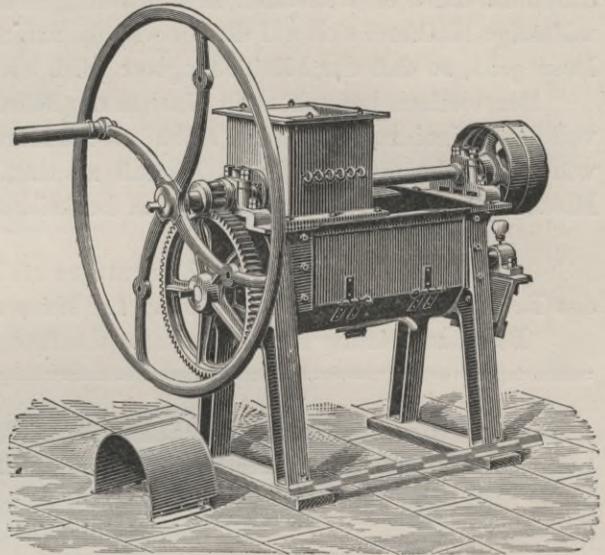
Mörtelmischmaschine für Handbetrieb.
